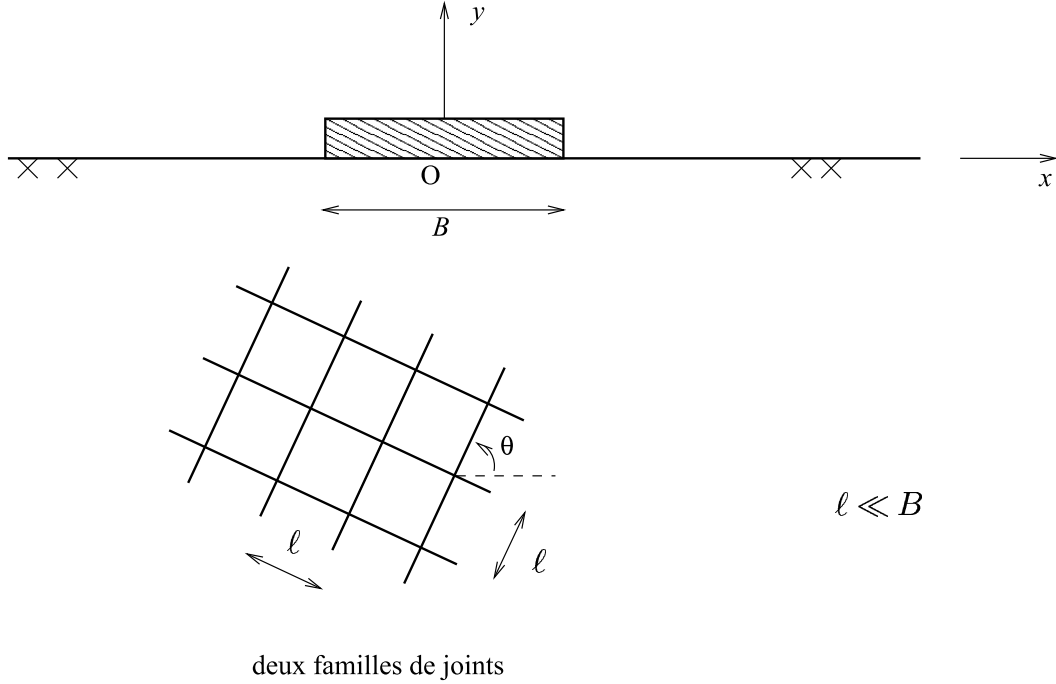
Fondation sur un massif traversé par deux familles de joints.
